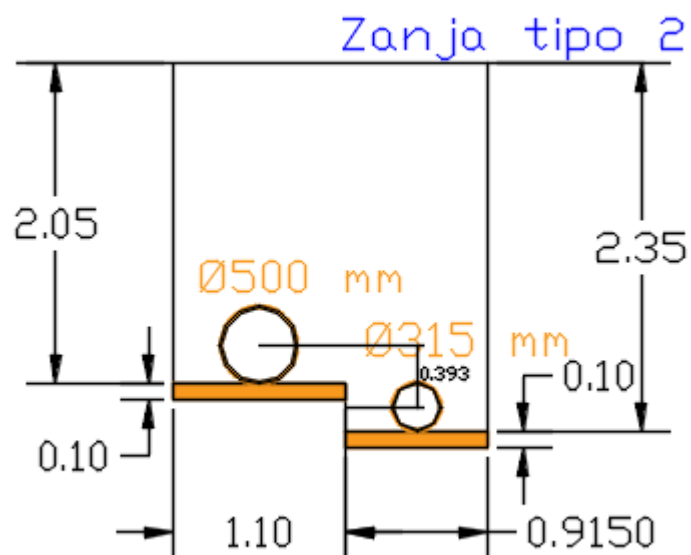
Zanja tipo 2 acotada. Fuente: Autocad.
